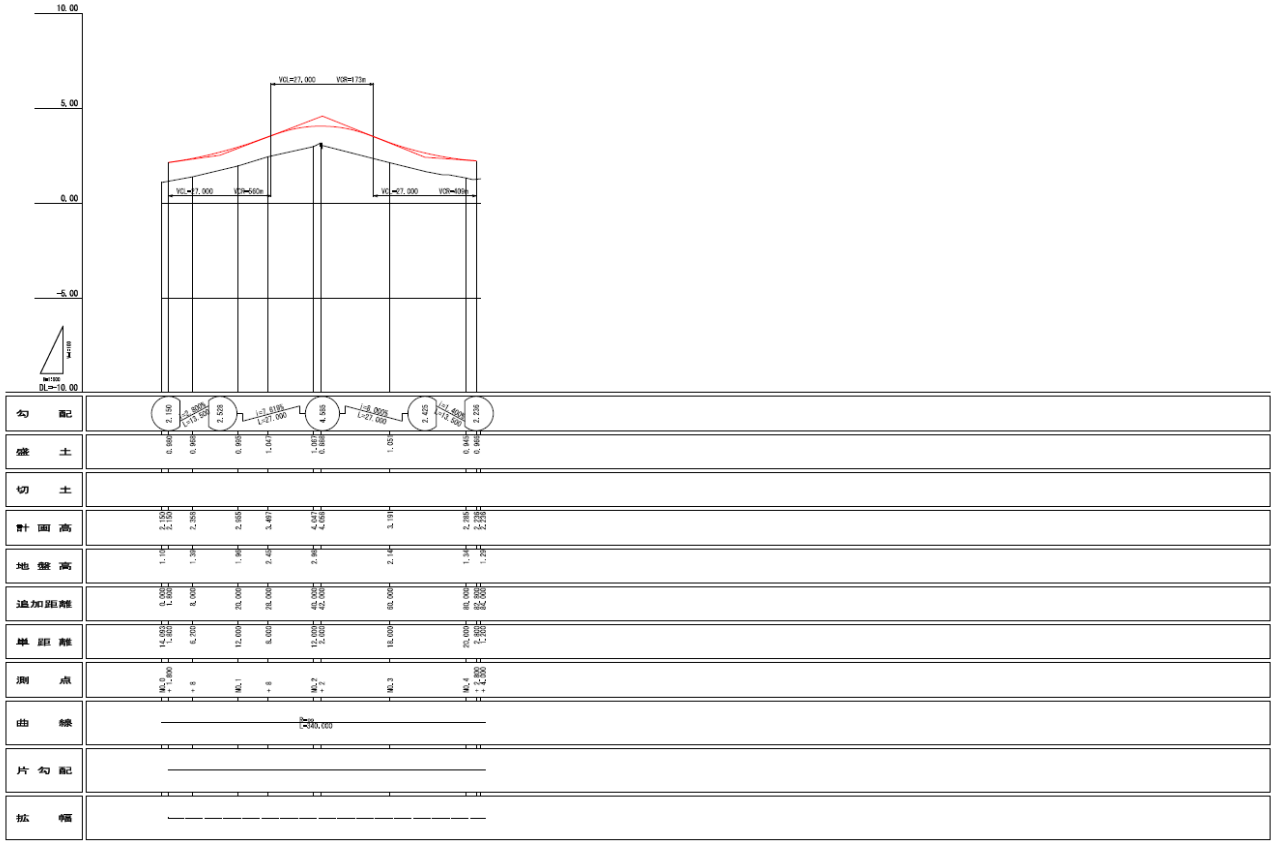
No.2 埠頭西 1 号線縦断面図（復旧後）
